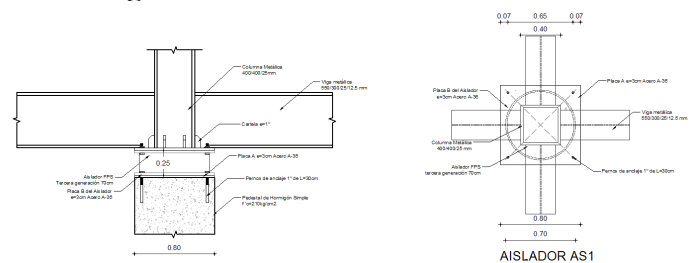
Ubicación de los aisladores en el Bloque estructural 1
